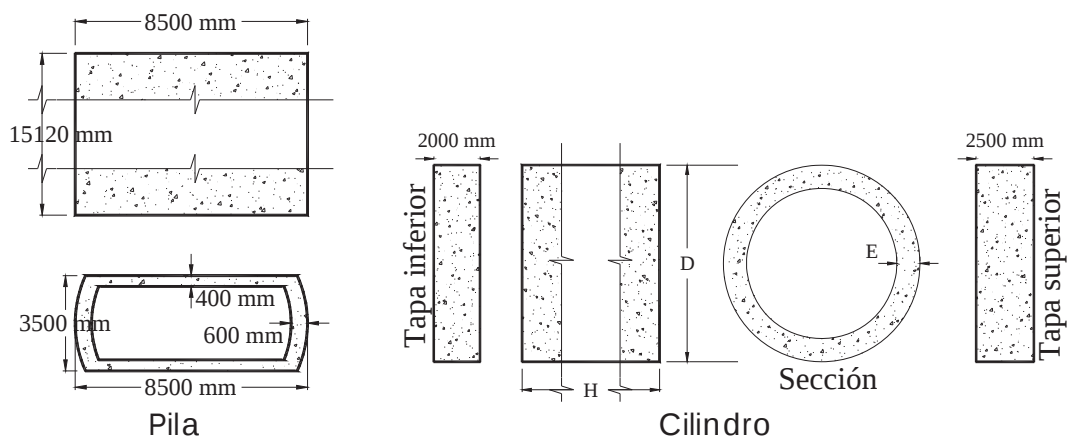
Dimensiones de los elementos de concreto reforzado.
